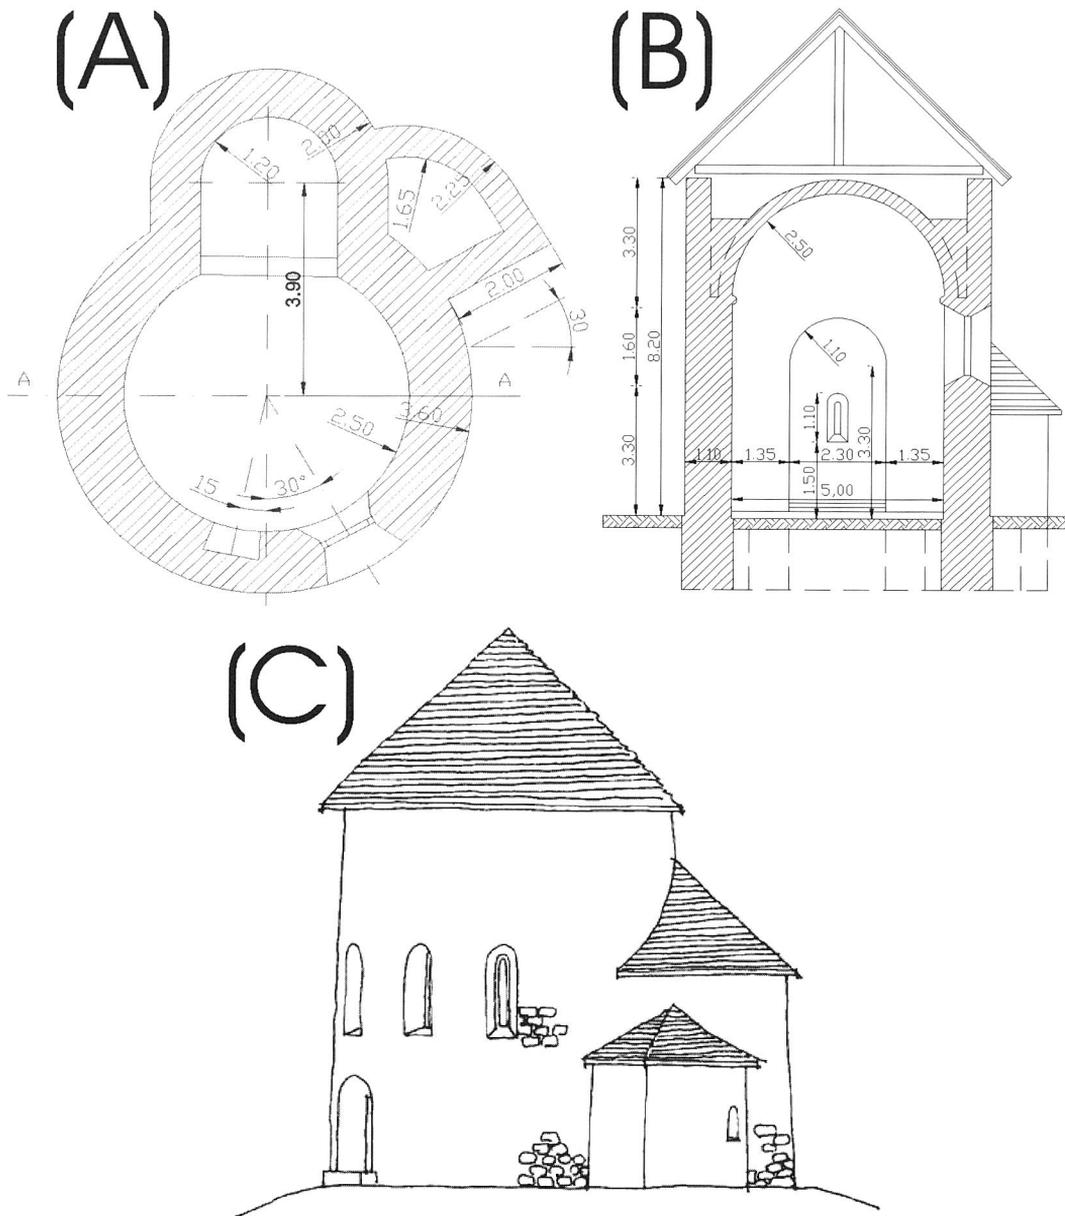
(A) Grundriss der rekonstruierten Rotunde. (B) Querschnitt der rekonstruierten Rotunde. (C) Südfassade der rekonstruierten Rotunde.
